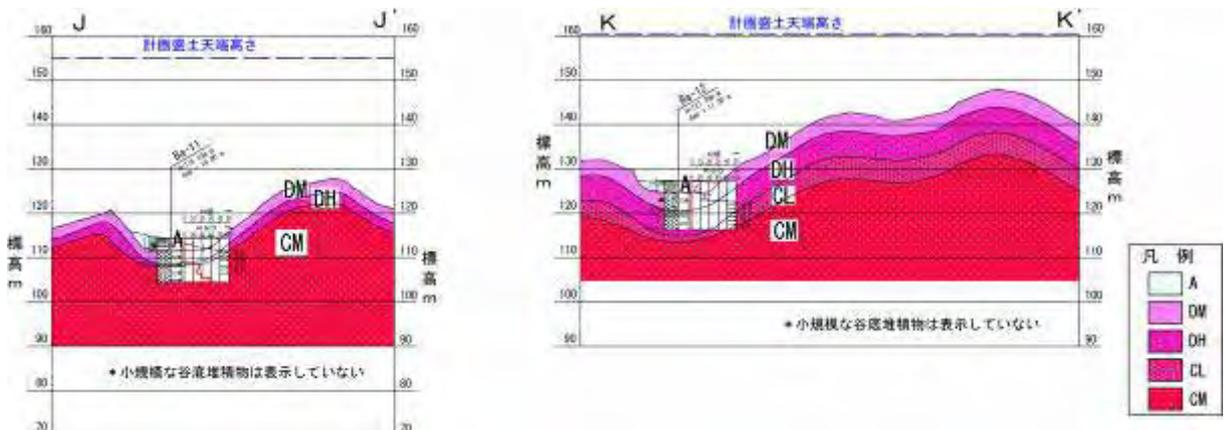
(11) 想定地質断面図 J-J 、 K-K
